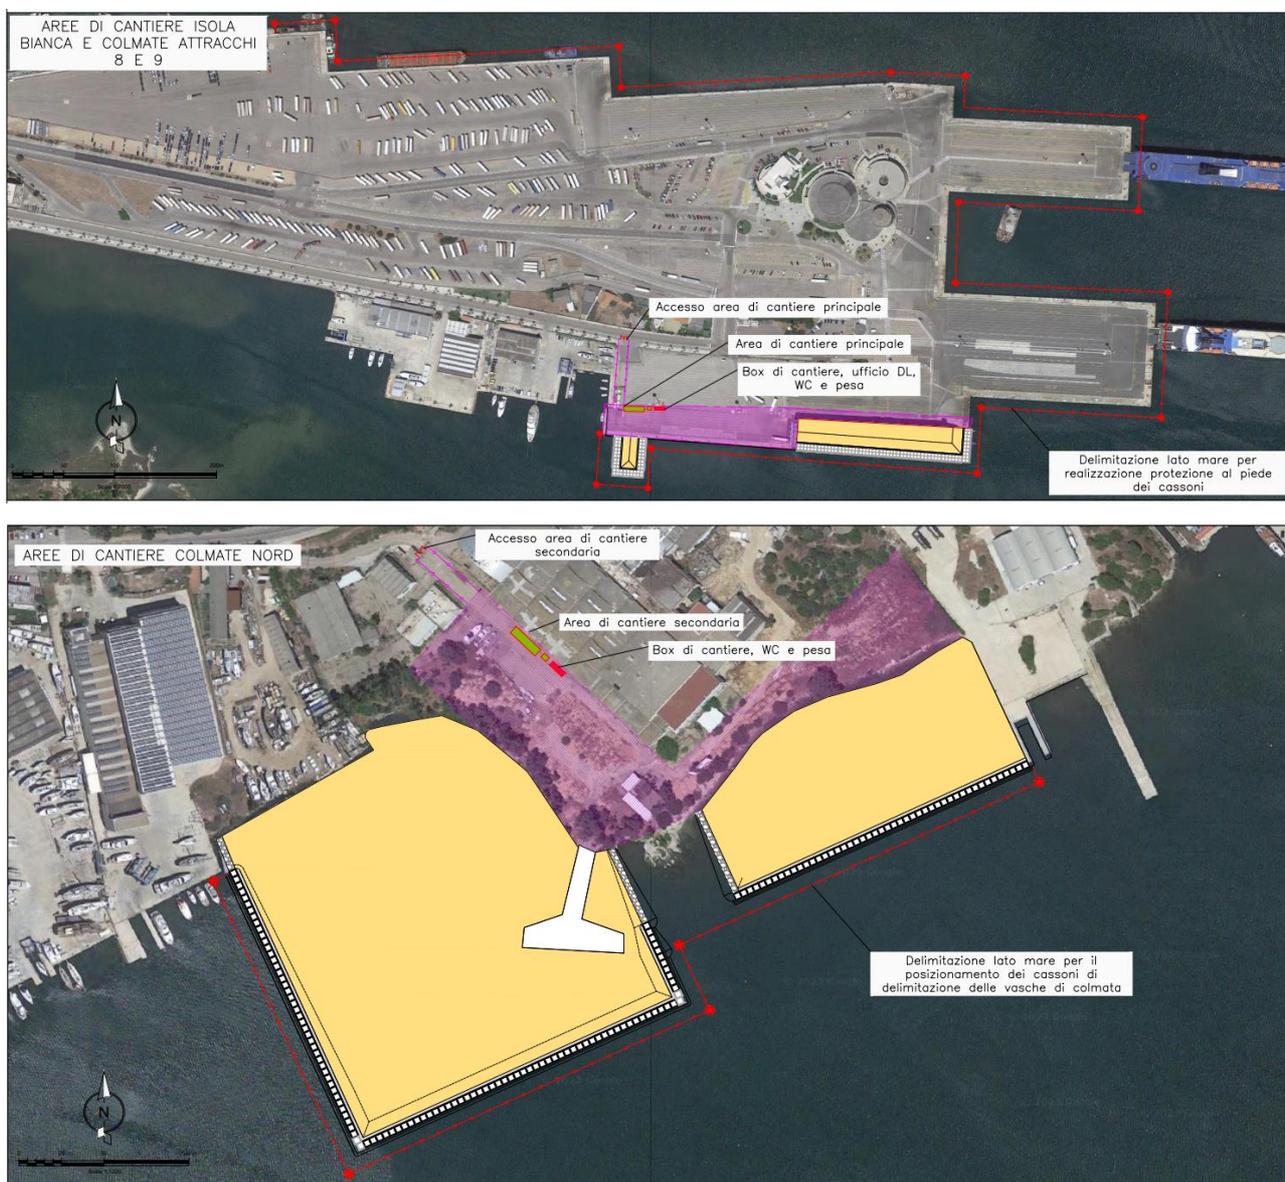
Individuazione delle aree di cantiere principale presso Isola Bianca (sopra) e dell'area di cantiere secondaria presso l'ex pontile Palmera (sotto).
